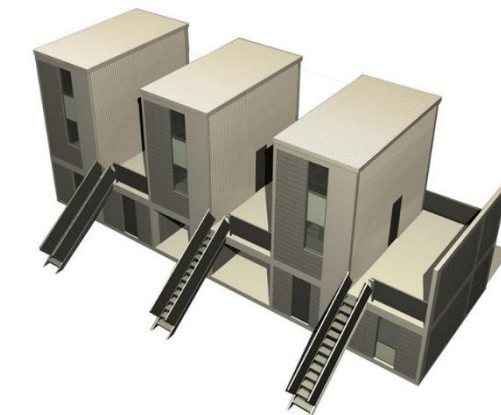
Fase 6: Colocación de sistema de cerramiento en cubierta y paredes.
